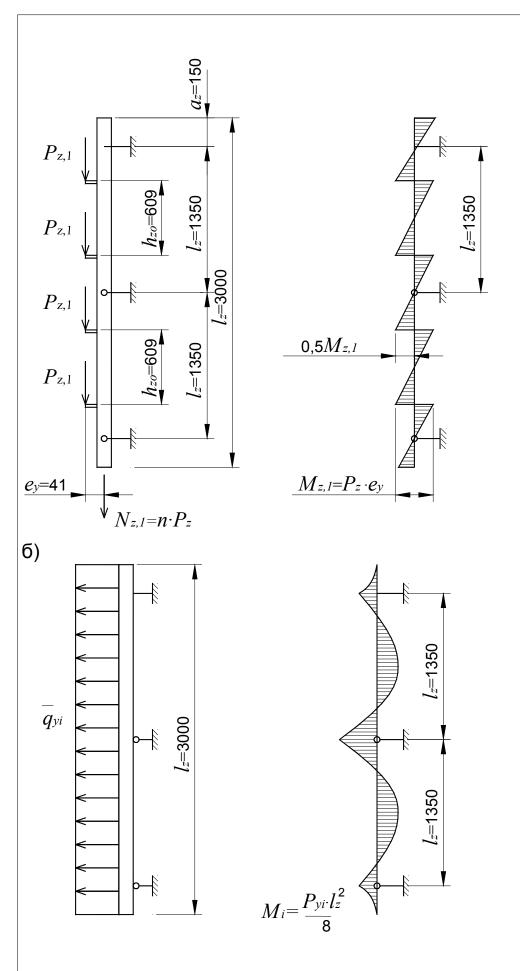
Расчетные схемы вертикального направляющего профиля а - на вертикальные нагрузки; б - на ветровые нагрузки.
